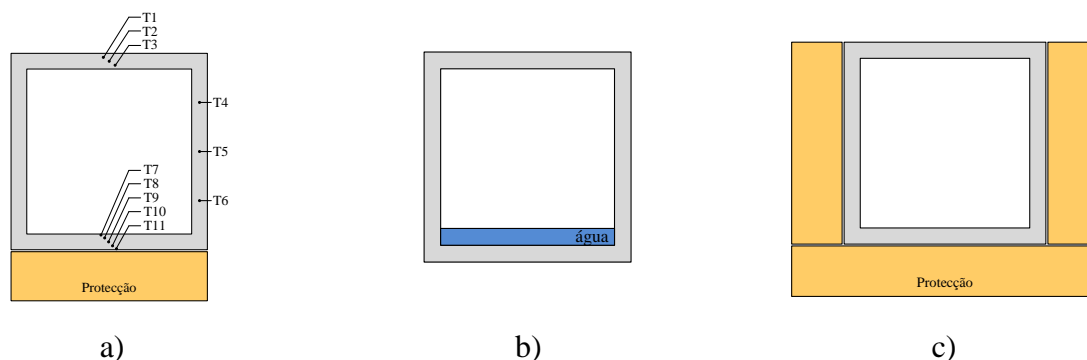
(a) Vigas com proteção passiva expostas a uma face (sendo indicada a posição dos termopares); (b) vigas com proteção ativa expostas a uma/três face(s); e (c) viga com proteção passiva exposta a três faces.
